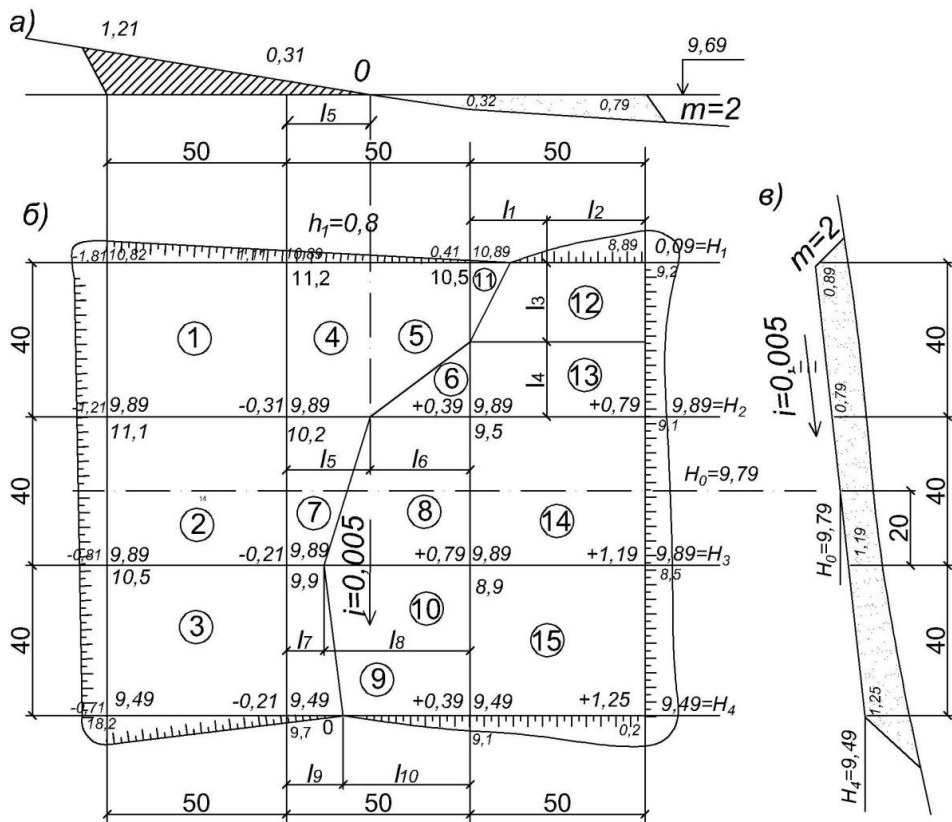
Схемы планировки площадки: а - схема продольного профиля; б - план площадки; в - схема поперечного профиля
